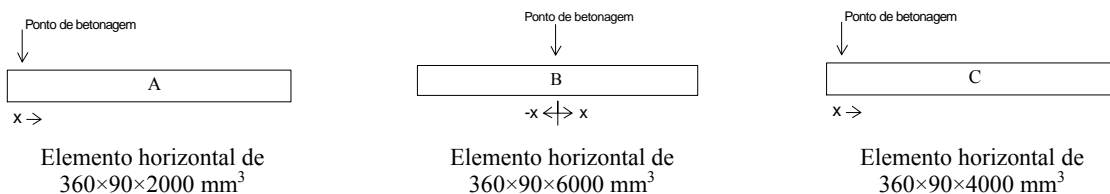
Pontos de betonagem em elementos com desenvolvimento horizontal.
